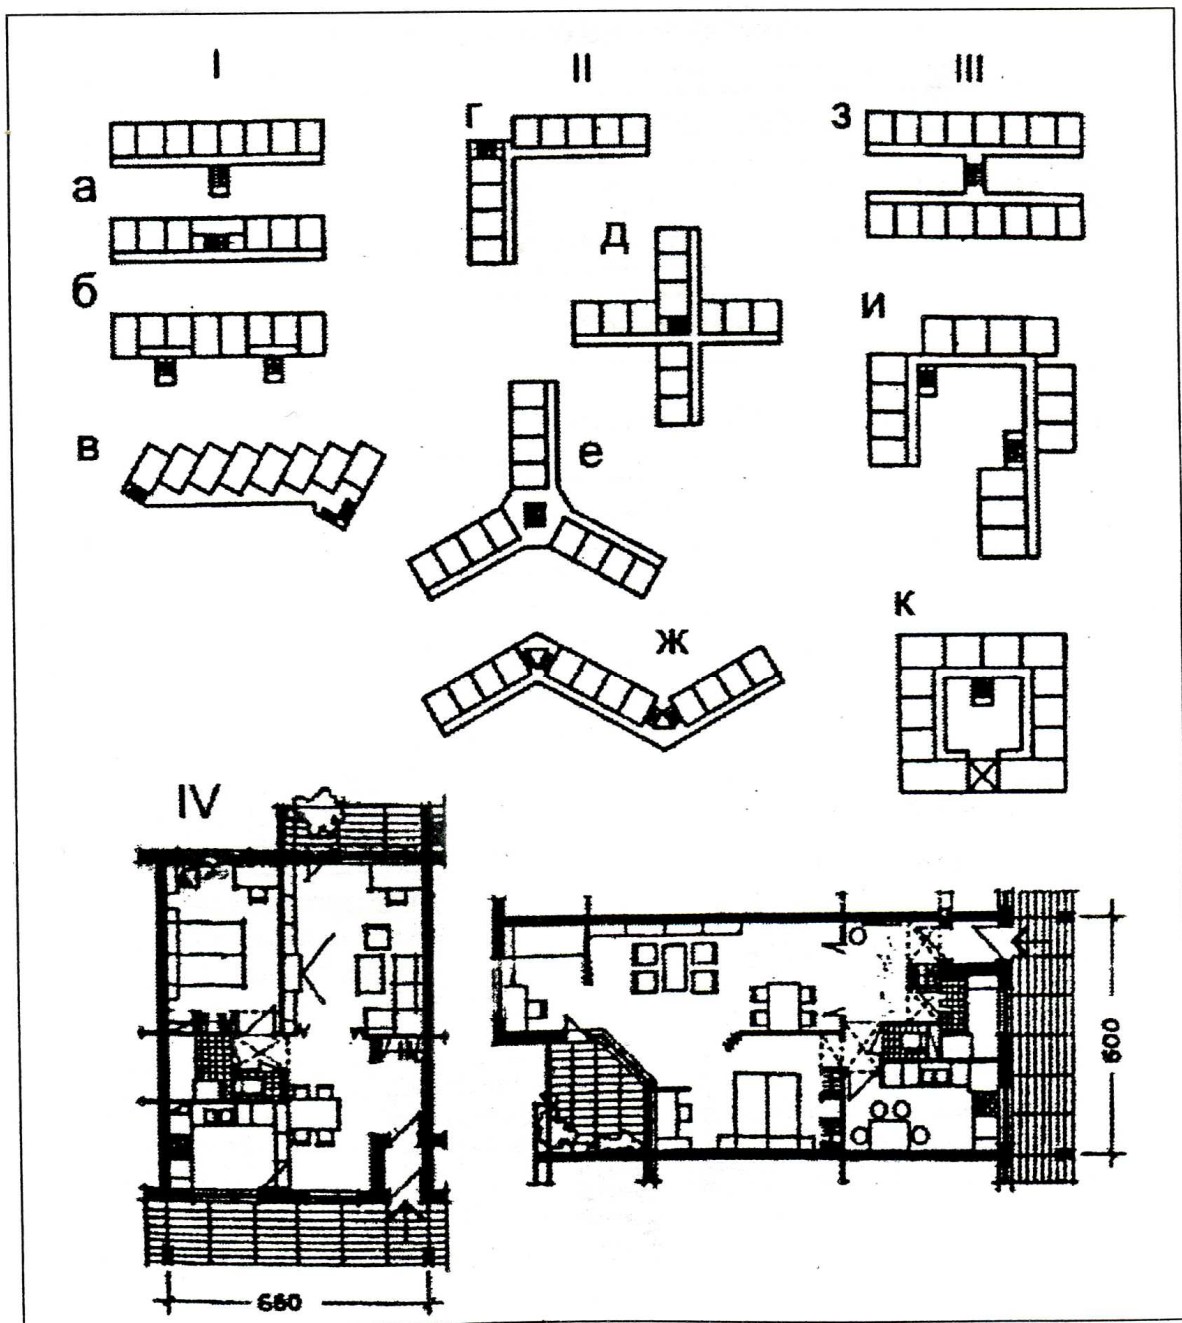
Галерейные дома с галереей на каждом этаже: I – линейные: а – прямоугольный, б – галерейно-секционный; в – со подвижкой; II, III – сложные: г – угловой, д – хрестообразный; е – трехлучевой, ж – ломаный; з – спаренный; и – П-образный; к – с внутренним двором; IV – варианты двухкомнатных квартир
